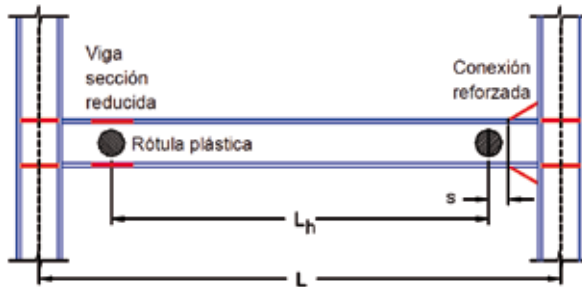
Ubicación de rótulas plásticas en vigas con distinto tipo de conexiones (Fuente: Crisafulli, 2012)
